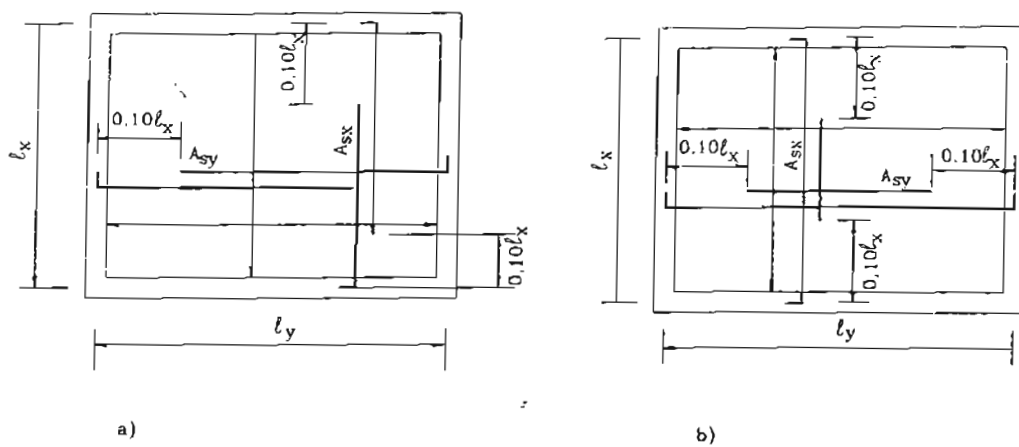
Comprimento das barras longitudinais para vãos isolados
